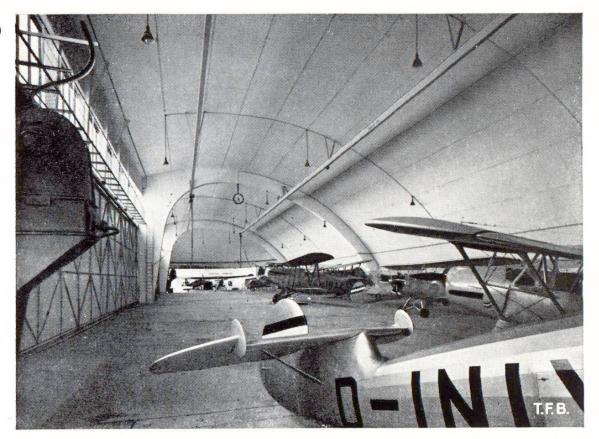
Hangar en béton armé pour avions de sport. Voile mince construit par Dyckerhoff & Widmann
